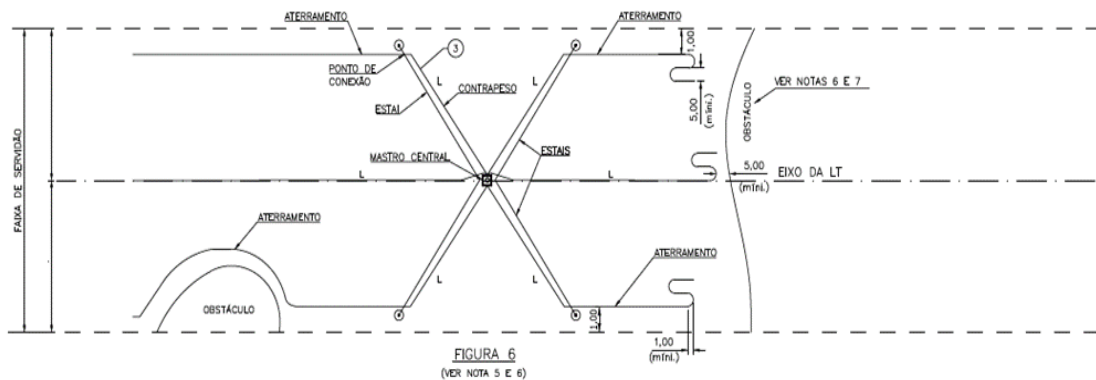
Detalhe do aterramento de estruturas estaiadas.
